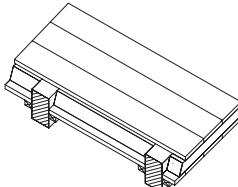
Armiranobetonska rebrasta in rebričasta plošča.
